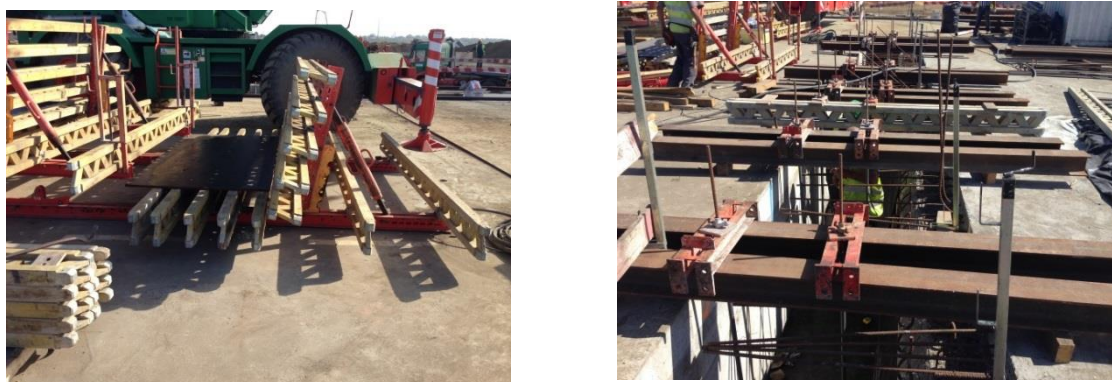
A: Cofragem para as vigas transversais; B: Montagem da cofragem e da armadura das vigas transversais
